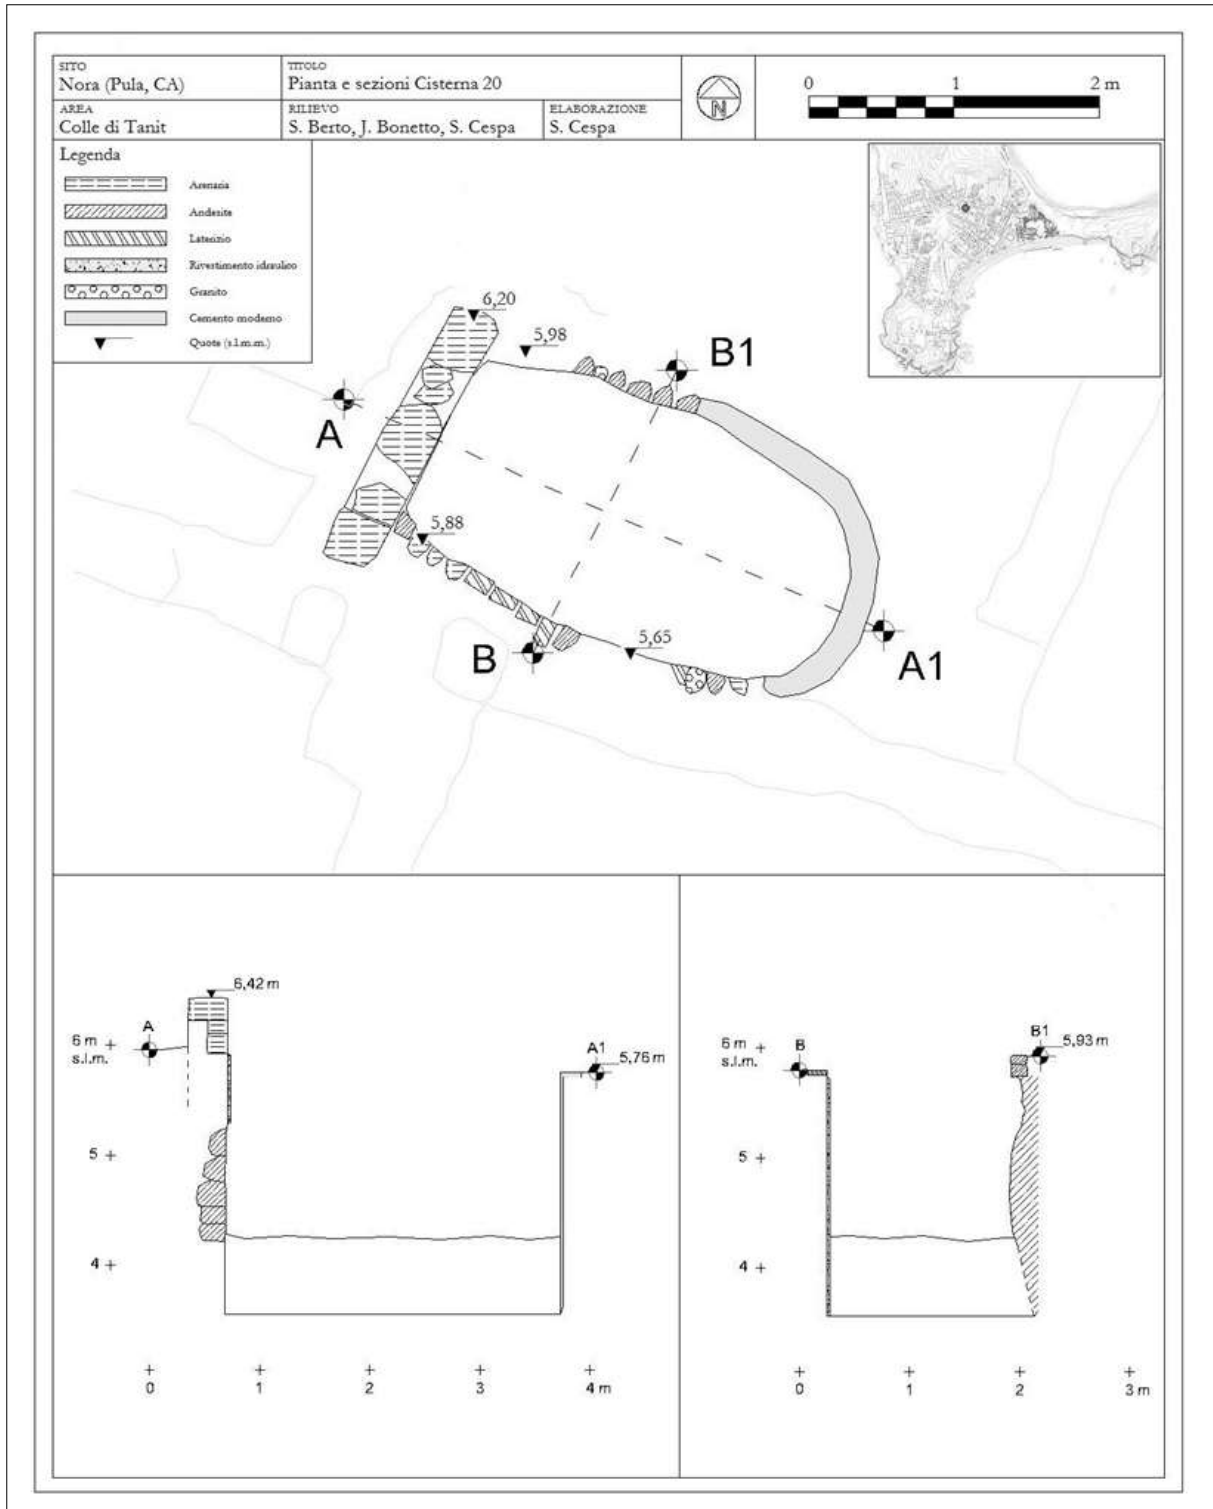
Pianta e sezioni della cisterna 20 (elaborazione dell'autore).
